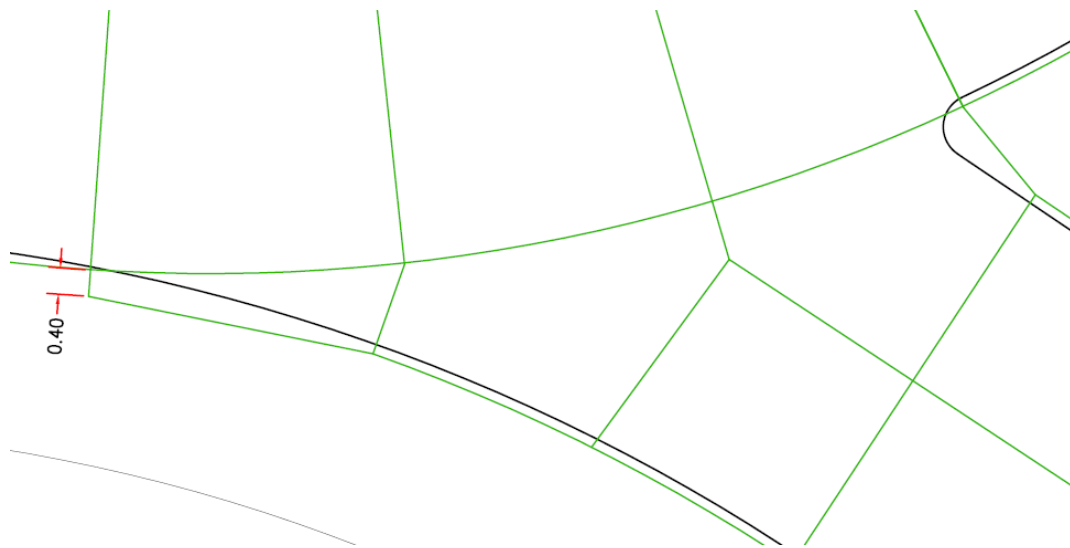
Modulación de losas de  $H^0$  en intersección de la rotonda y ramal saliente sureste.
